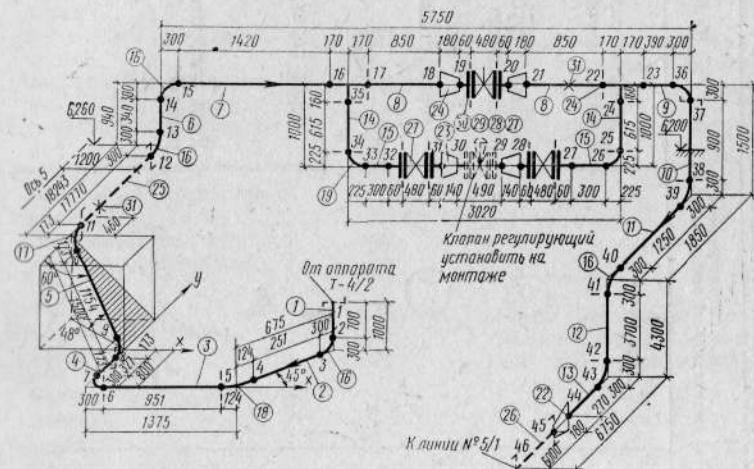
Монтажно-сборочная схема трубопровода без разбивки на элементы
